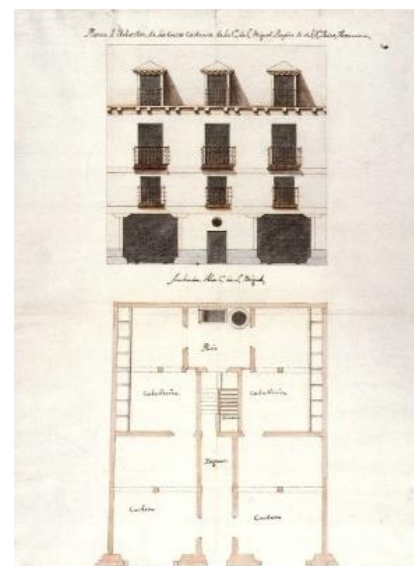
Caballerizas centrales en planta baja: reflejo en fachada. Fuente: Blasco (2006).
